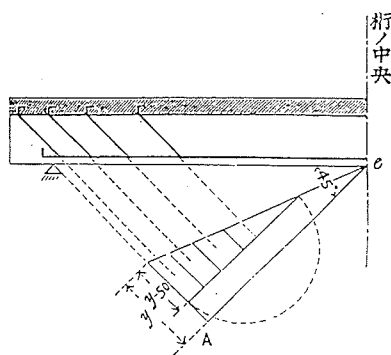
鉄筋コンクリートT桁、折曲げ鉄筋設計図<sup>22)</sup>
